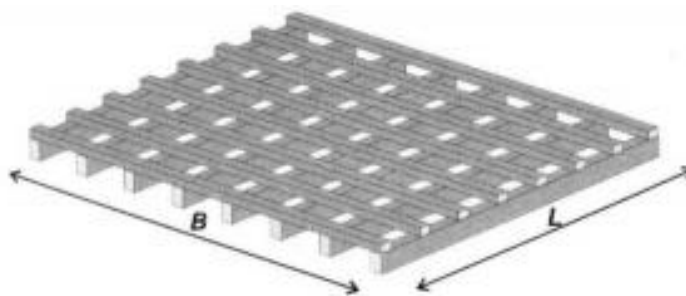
Pavimento/tabuleiro de madeira – vigas principais e secundárias. (Martins, 2010)
